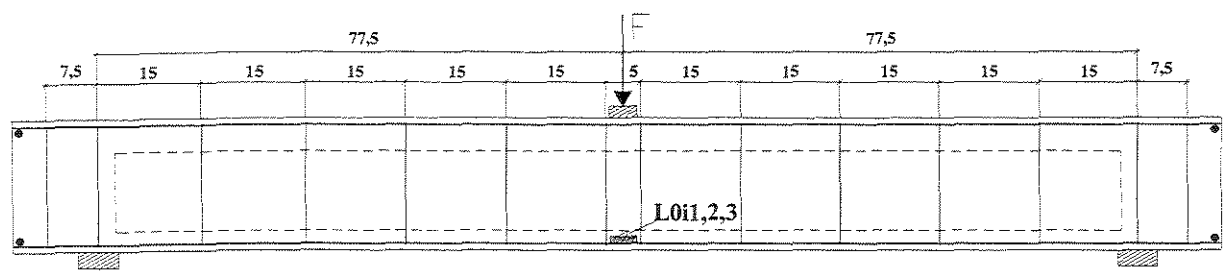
Tensões na armadura longitudinal tracionada das vigas HC
